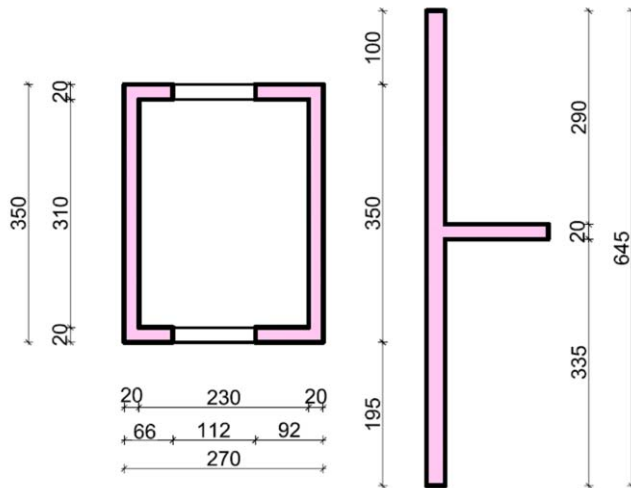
Grundriss - Kern mit T-Stück
